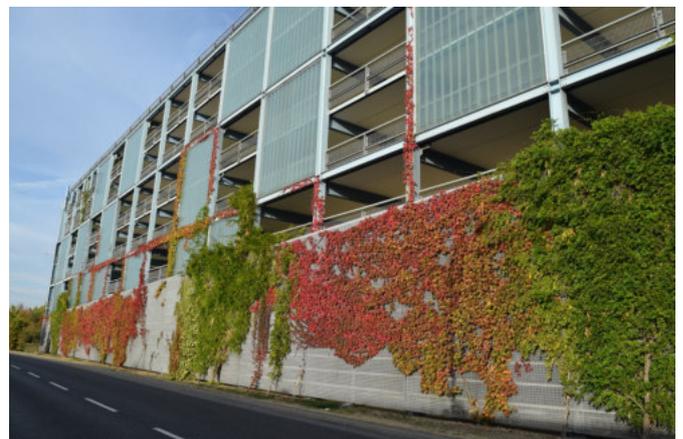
Fassadenkonstruktion in Stahlbauweise mit Gerüstkletterpflanzen auf Gitterstruktur (BuGG)
